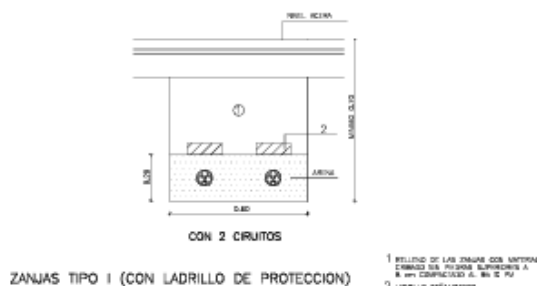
Sección zanjas de las instalaciones de electricidad. Red de tomas. Fuente: Plano I-03 Proyecto de infraestructuras soterradas permanentes para el evento Carreras de Caballos en playa de Sanlúcar. Avenida de las Piletas, S/N, Sanlúcar de Bda (Cádiz).
